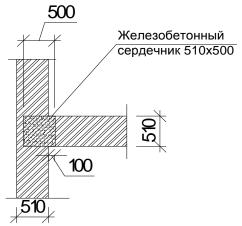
Предлагаемое расположение железобетонной колонны в теле стены на Т-образном пересечении
